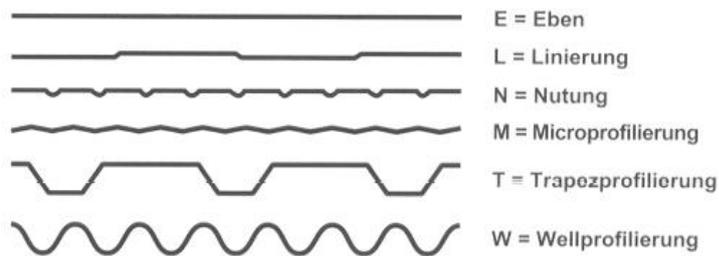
Profilierungsvarianten der Deckbleche von Sandwichelementen
